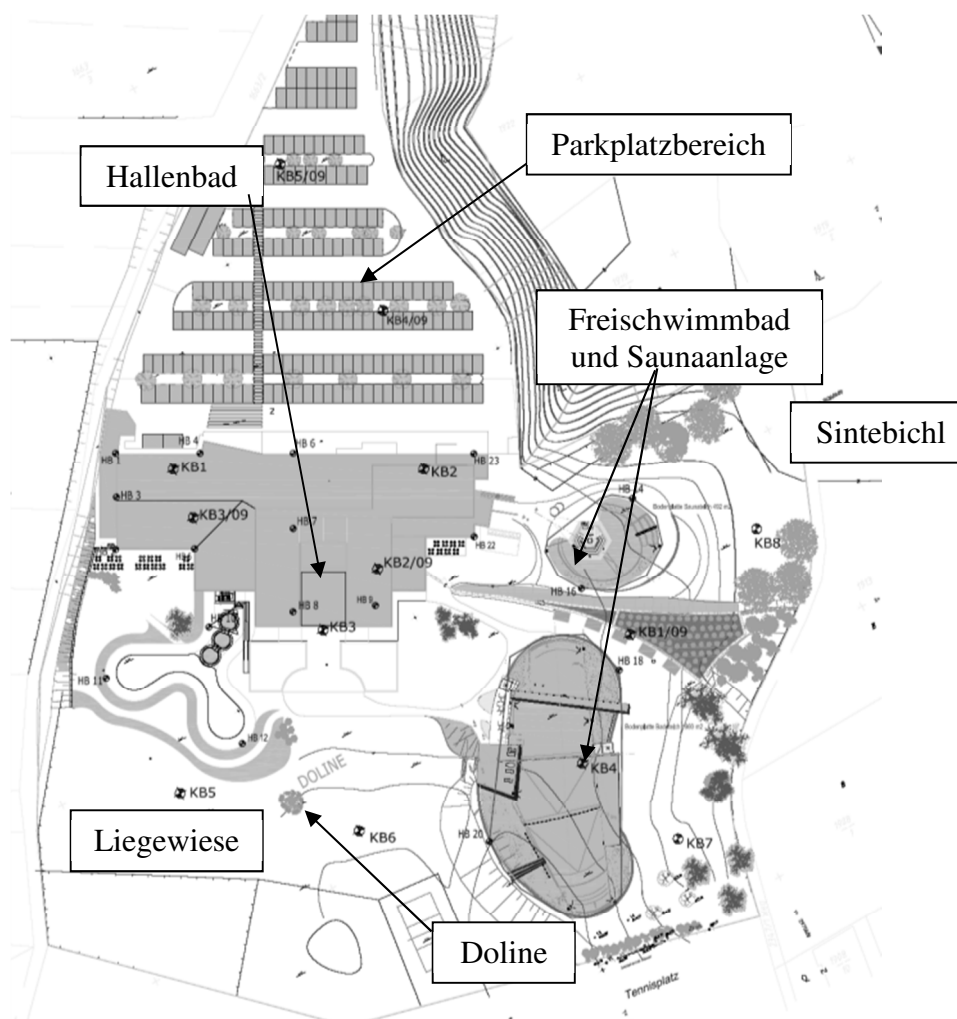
Ausschnitt Lageplan (Plangrundlage „E007 LP01“ Architekturbüro Walch, 2009)
